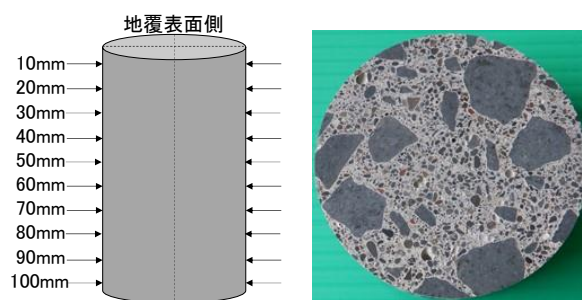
超音波伝播速度の測定位置 写真-3 研磨した供試体
